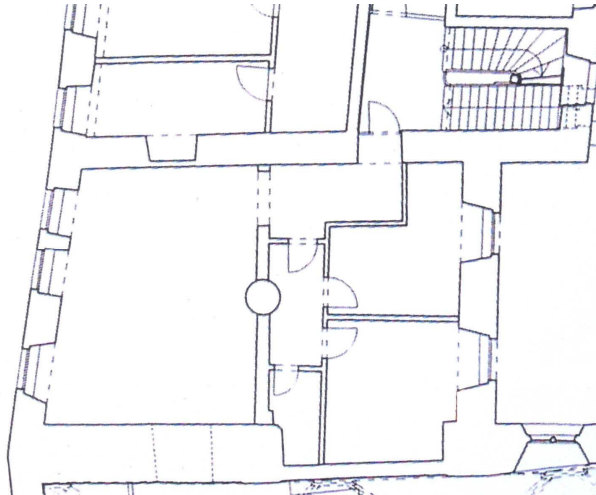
Grundriss der Dominikuskapelle, erstes Obergeschoss.
